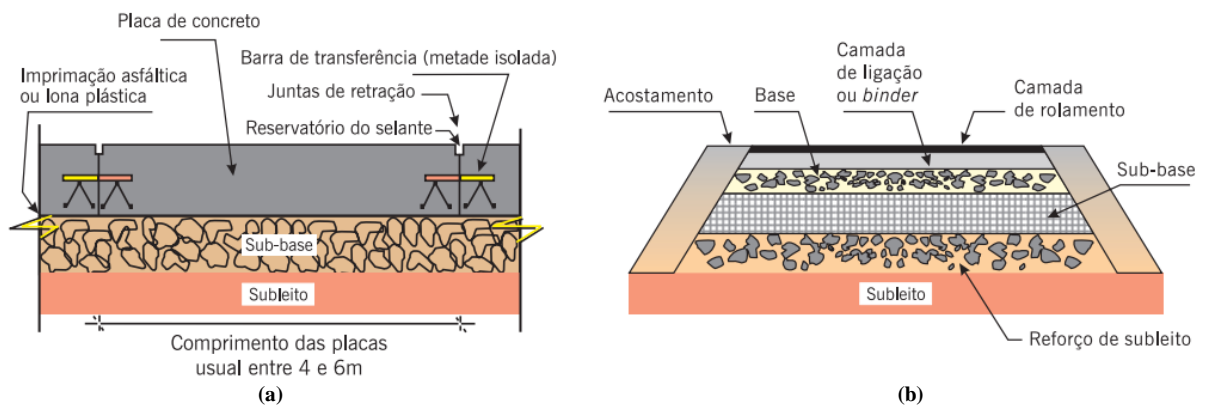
(a) Corte longitudinal de pavimento rígido e (b) Corte transversal pavimento flexível
